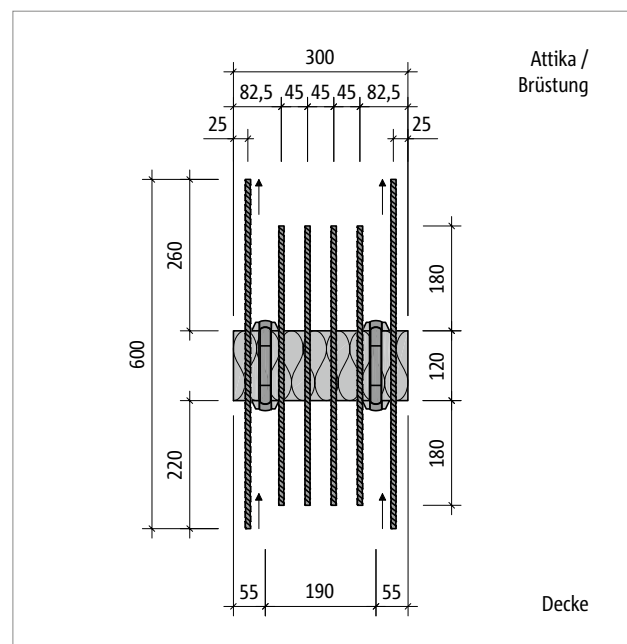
Schöck Isokorb® CXT Typ A-MM1-REI30-LR240: Produktansicht für Deckendicke D = 220 mm - Eckstäbe sind um -20 mm verschoben.
